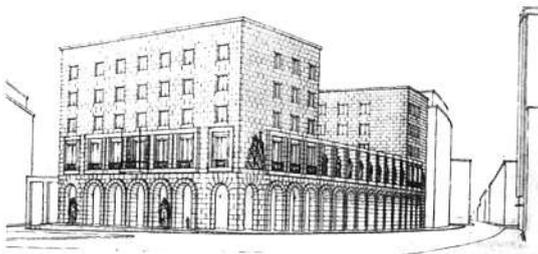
Vista prospettica del fronte principale, progetto di Nordio.
